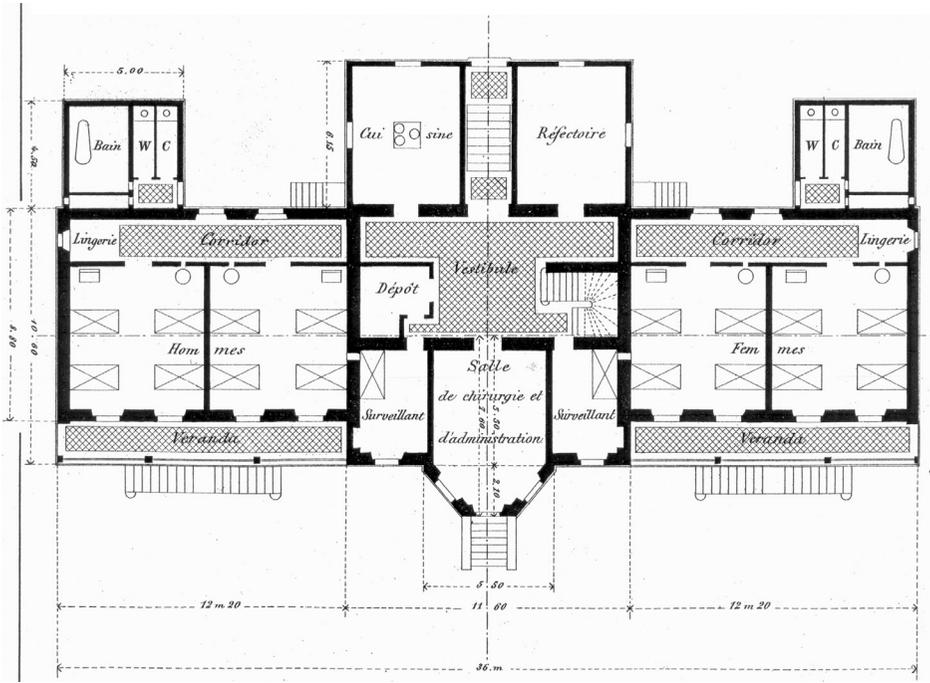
Payerne, infirmerie (1885), plan du rez-de-chaussée (tiré de : BSVIA, 1884).
